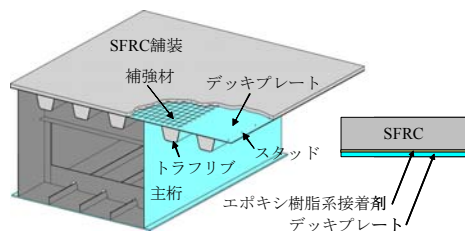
SFRC 舗装による鋼床版補強工法の構造概要
